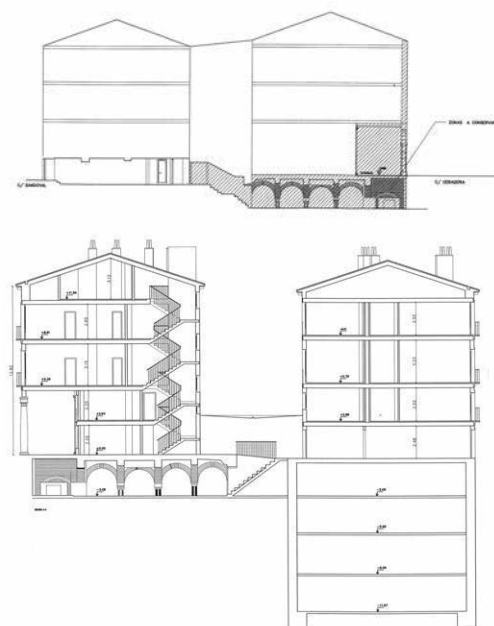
/ Edificio situado en la calle Cebadería 3, antes de su demolición y el nuevo edificio proyectado.
